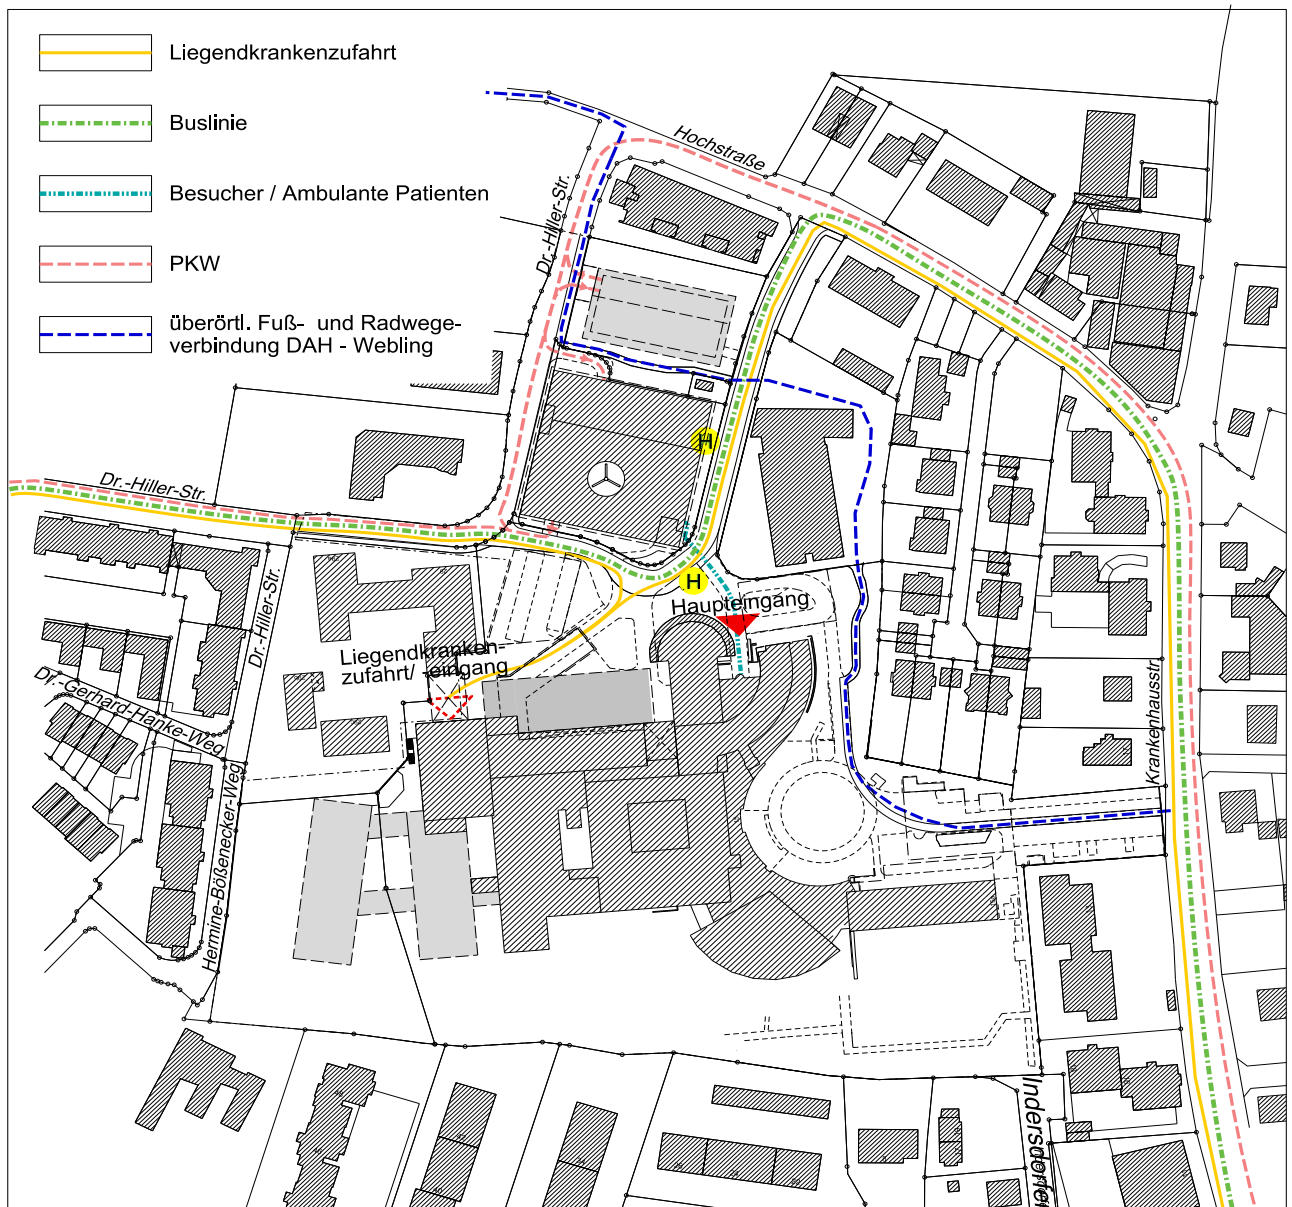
Lageplan Übersicht Erschließungsstruktur, ohne Maßstab
